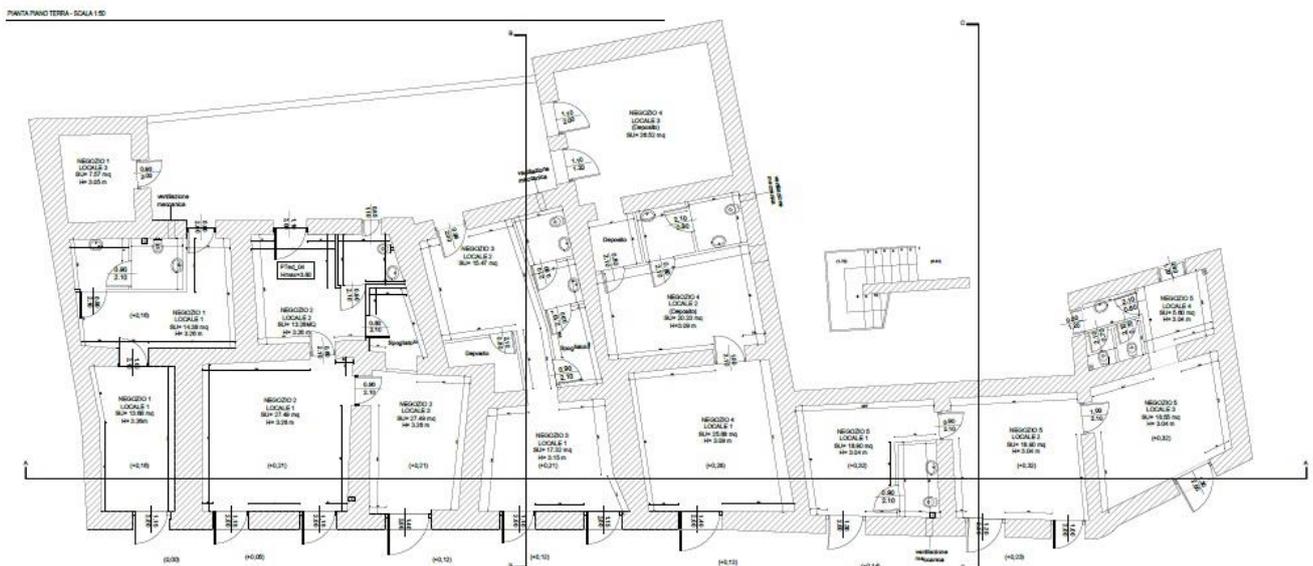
Progetto architettonico edifici D/E (pianta piano terra)
